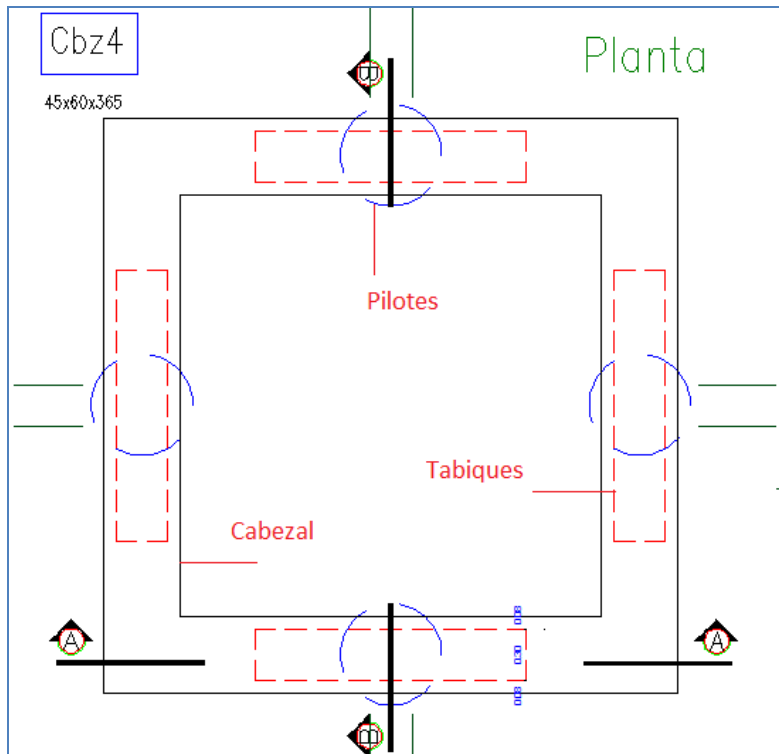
Planta de estructuras de la fundación del núcleo de tabiques de la rampa helicoidal.
